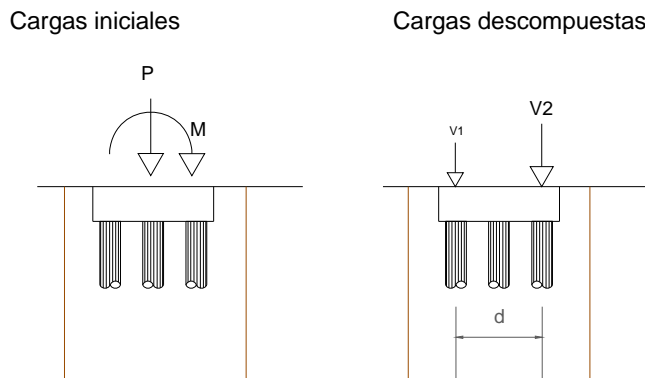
Cargas iniciales grupo de tres pilotes y cargas descompuestas para cálculo.
